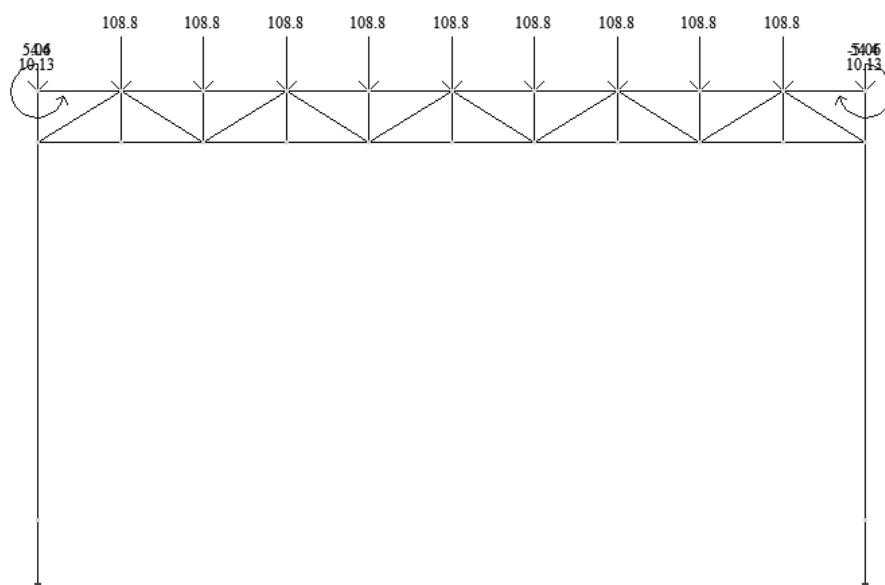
Нагружение «вес покрытия и стен»
